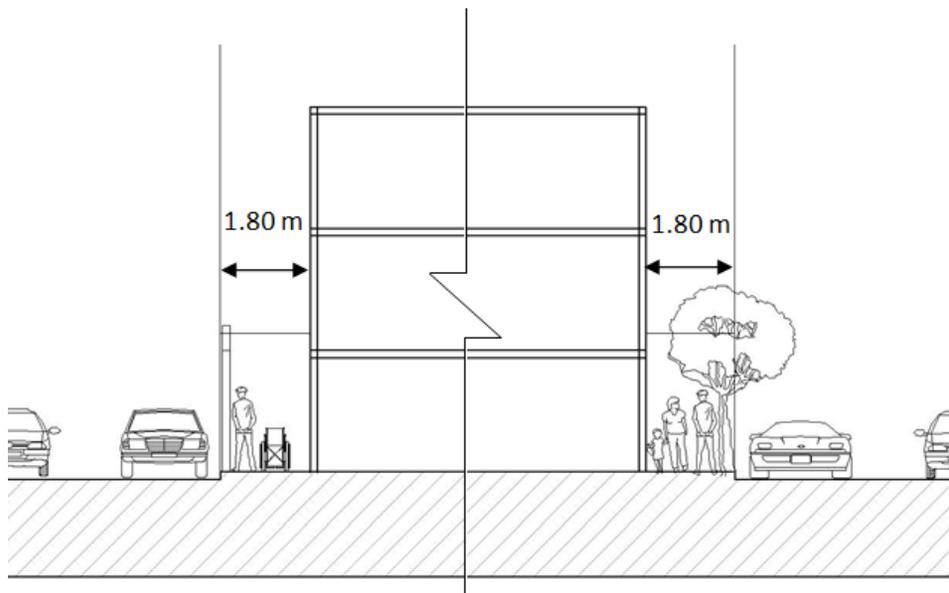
Corte esquemático con banquetas de 1.80 m de ancho. Fuente: elaboración propia.
